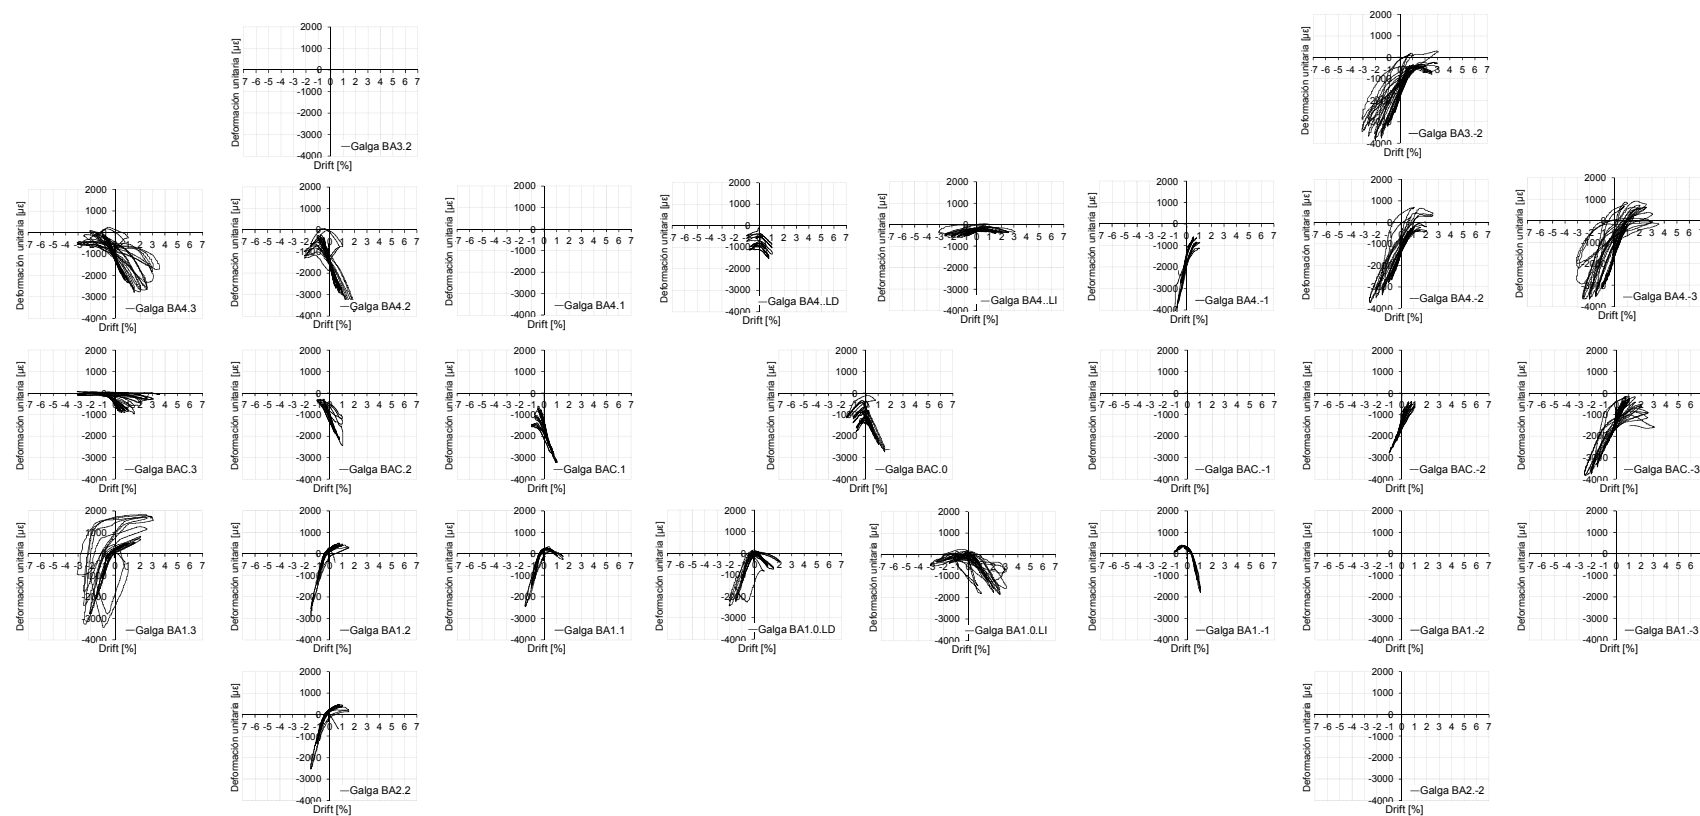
Medidas de galgas en armadura de vigas. A.VB.L1
